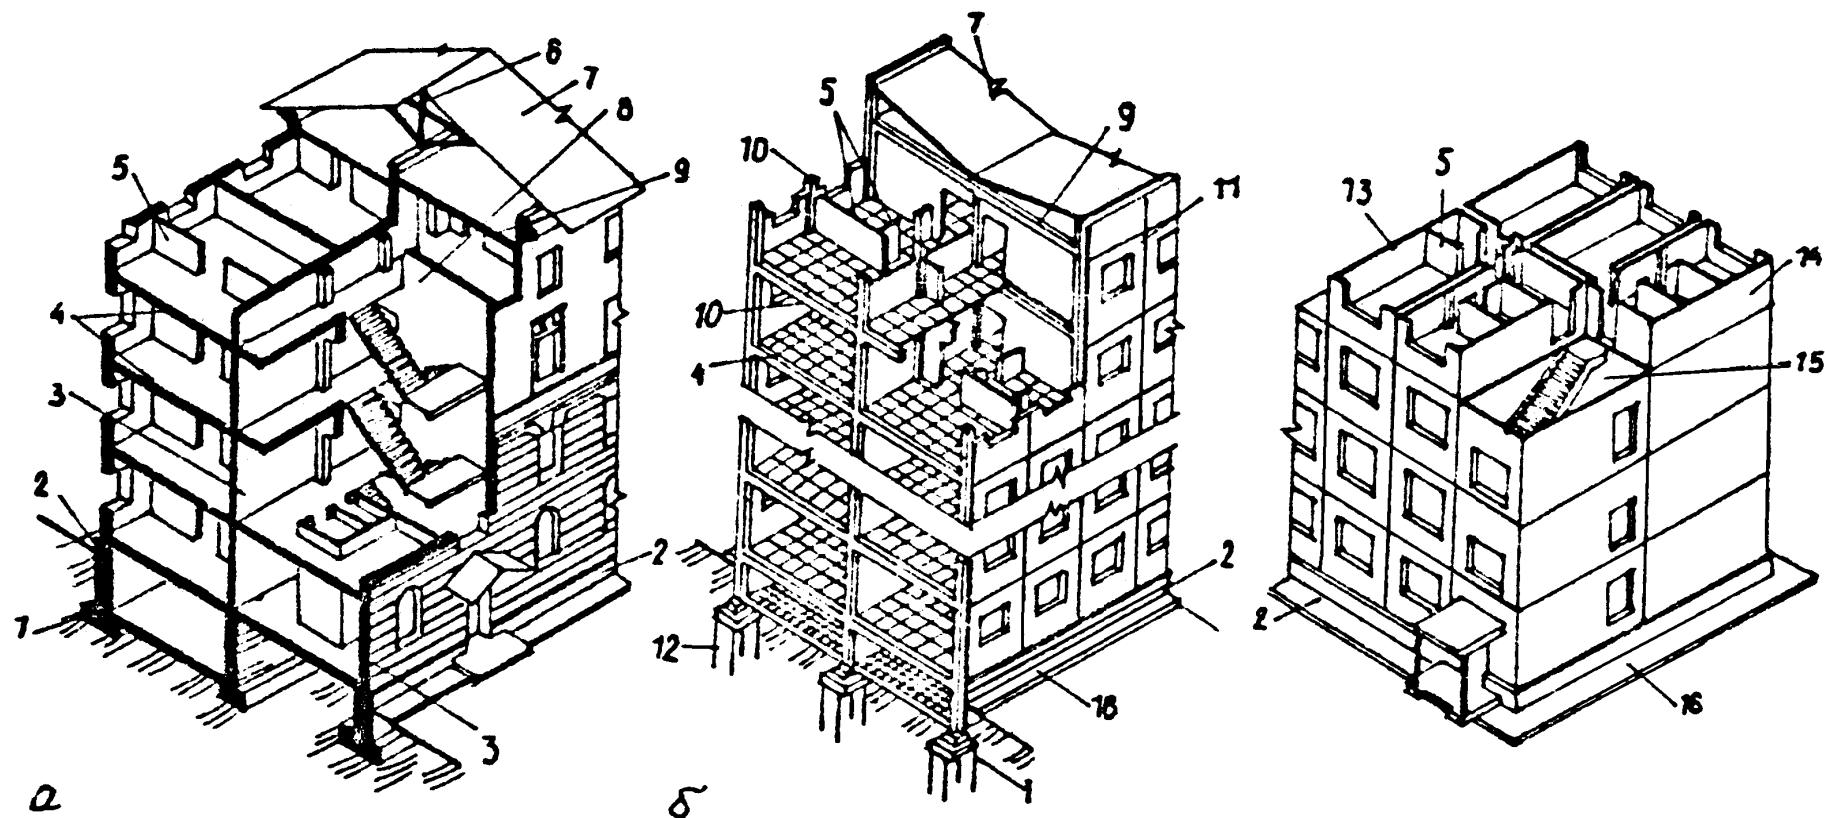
Схема основних елементів цивільних будівель: а – старої будови; б- каркасно-панельної будови; в – з об'ємних блоків; 1 – фундамент; 2 – цоколь; 3 – несучі поздовжні стіни; 4 - міжповерхові перекриття; 5 – перегородки; 6 – крокви даху; 7 – покрівля; 8 – сходові клітки; 9 – горищне перекриття; 10 – ригелі й колони каркаса; 11 – навітряні стінові панелі; 12 – палі; 13-15 – об'ємні блоки (13 - кімнати; 14 – санвузли і кухні; 15 – сходові клітки); 16 - відмощення
